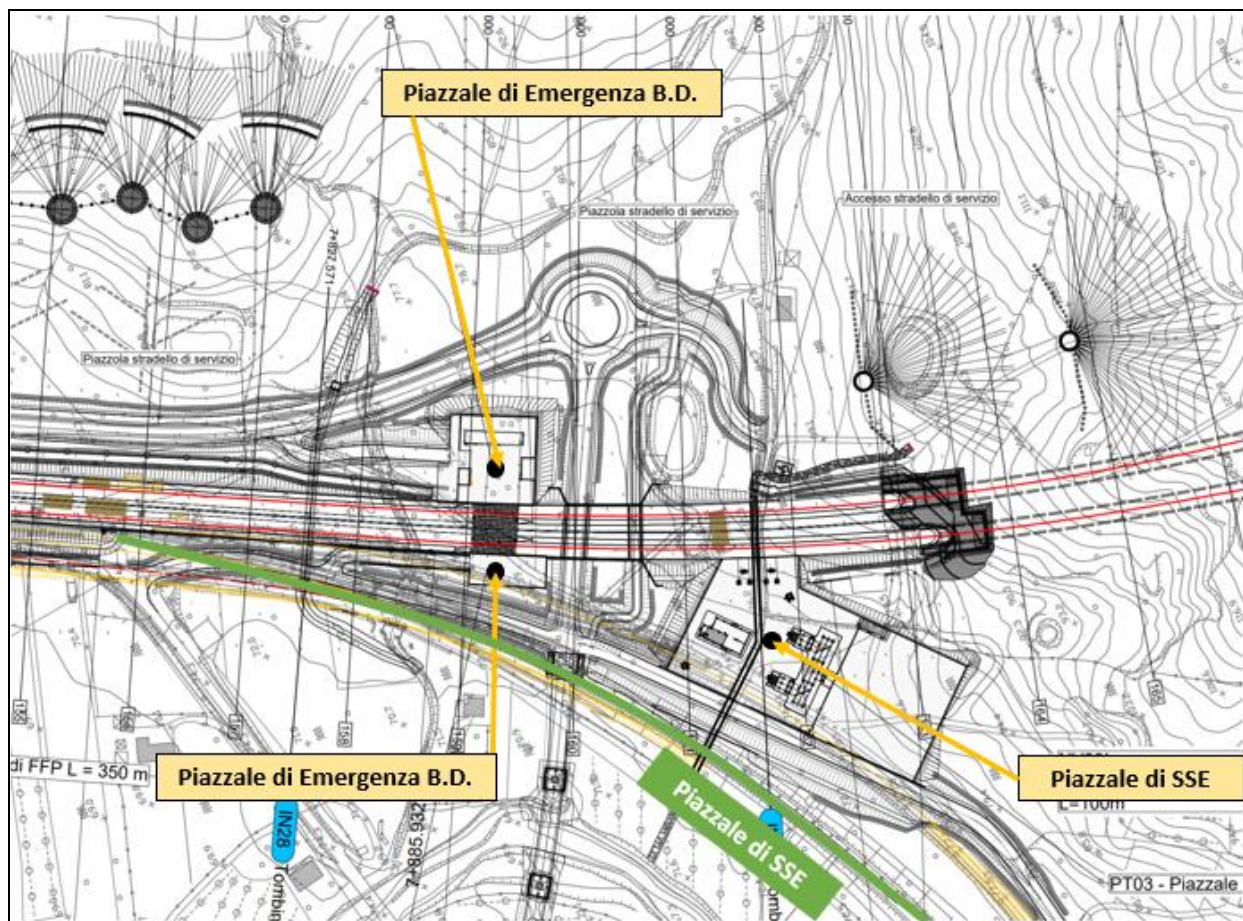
Assetto planimetrico opere zona di imbocco galleria lato Palermo
